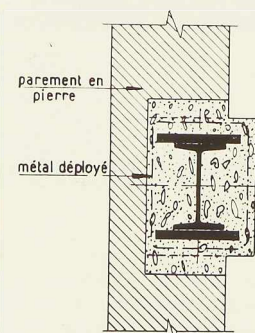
Détail d'enrobage des poteaux extérieurs.
